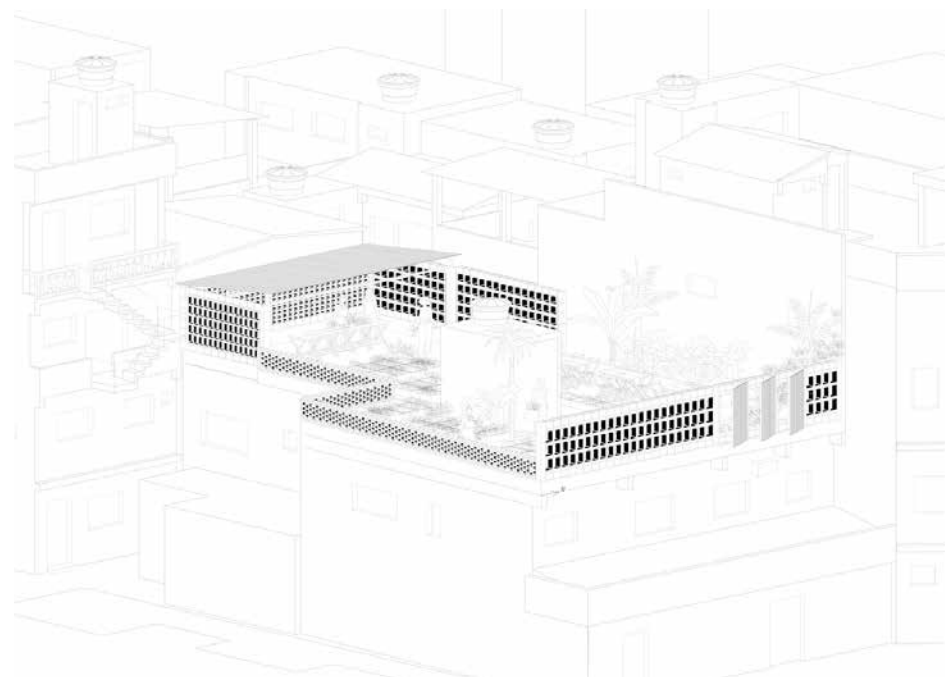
e 45. Projeto e vista da Laje com o projeto Horta na Laje
